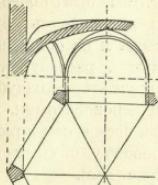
Крестовый сводъ на 6-ти угольномъ планѣ.
